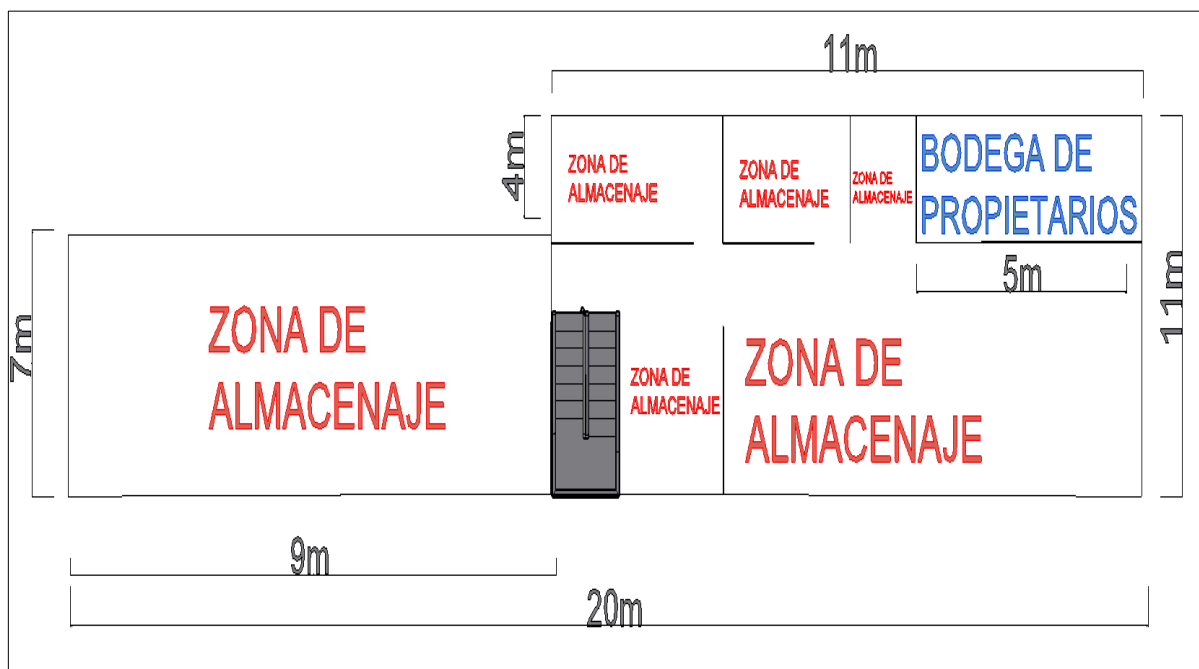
Vista superior y dimensiones de la tercera planta (plano 1)
